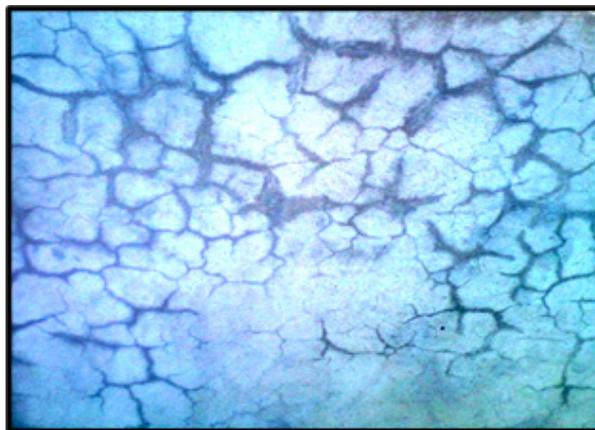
Se muestra agrietamiento en concreto por RAA.
